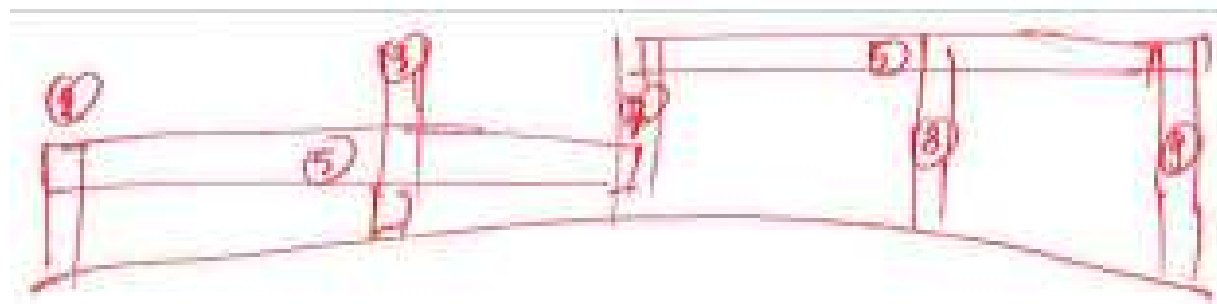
Drewniana konstrukcja dachu nad „Salą na Piętrze”
